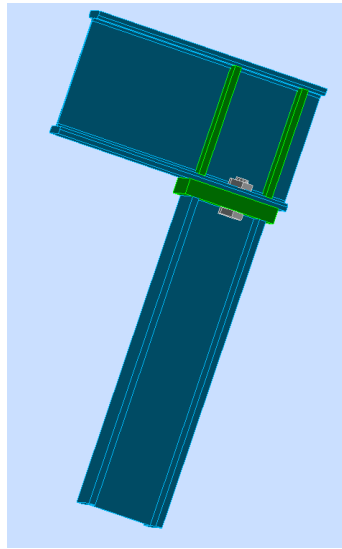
Diseño unión pilar auxiliar-viga (10m)
